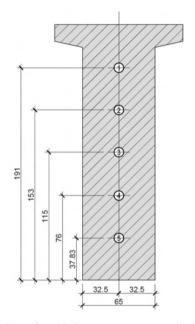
Modelo de seção de viga pré-moldada em concreto armado utilizada em passagem de fauna elevada
